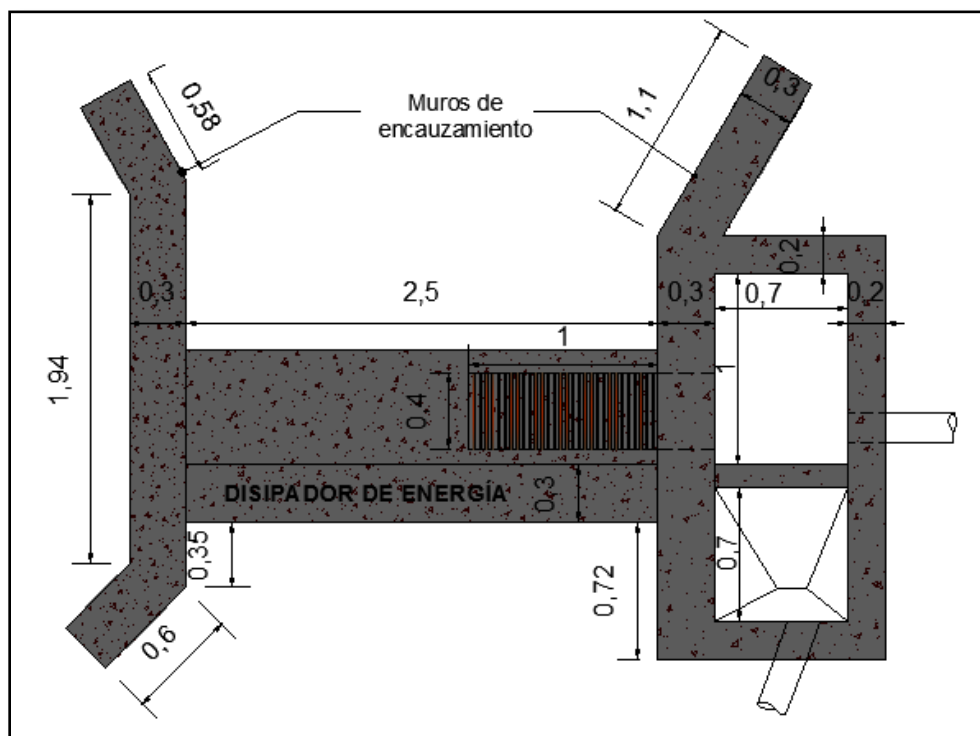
Plano en planta de bocatoma proyectada. Fuente: Autores del proyecto.
